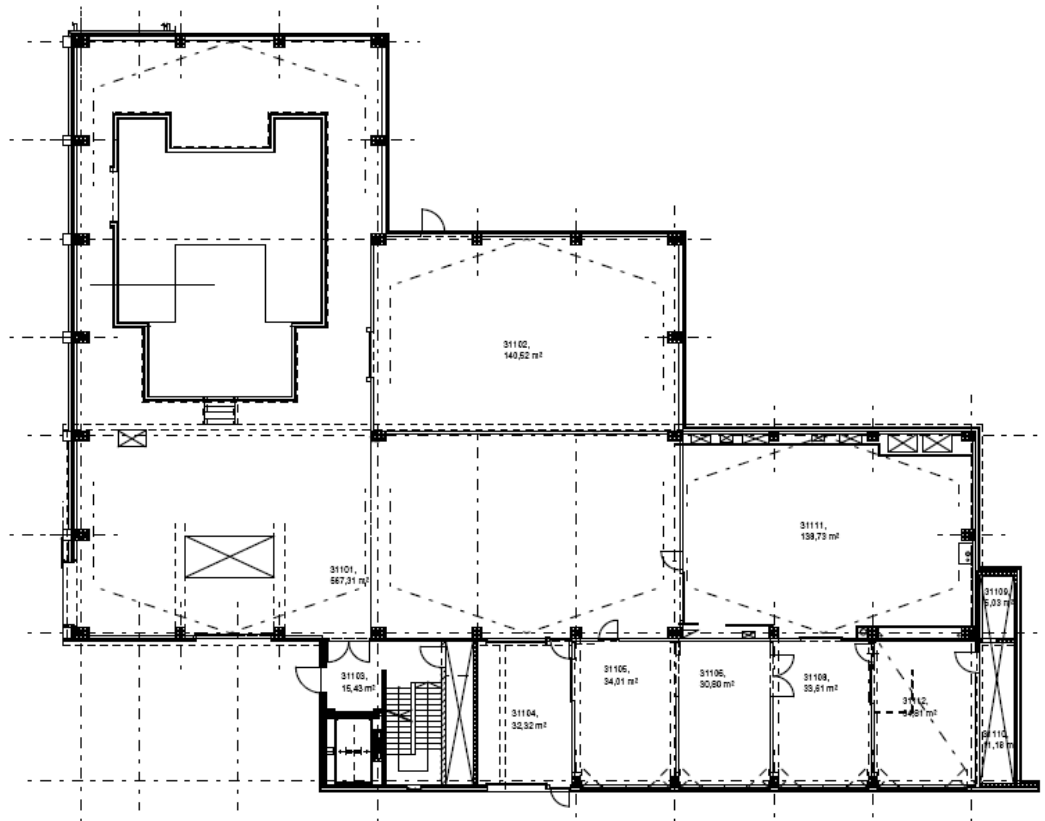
Grundriss B_31, Bauabschnitt 1
